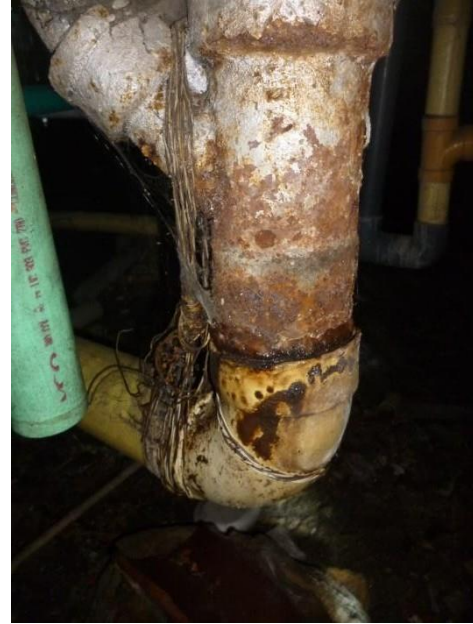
Unión entre tubería PVC y HF en mal estado.
